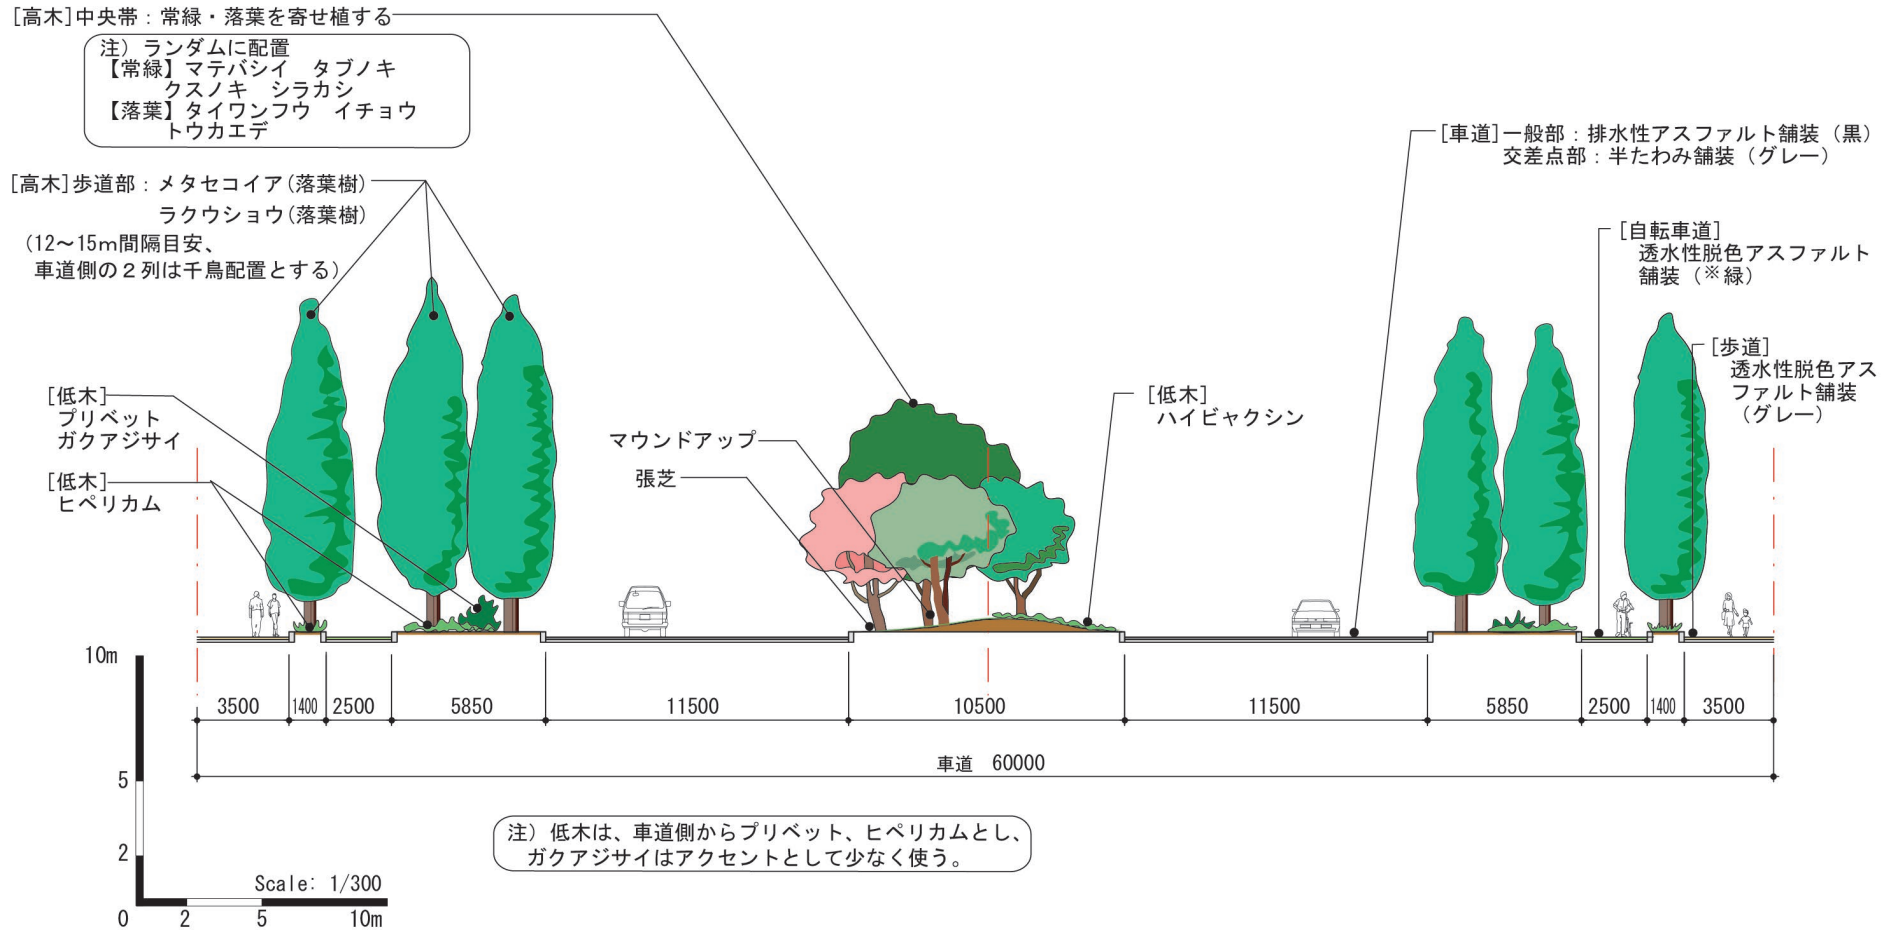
道路植栽計画図(臨港道路アイランドシティ1号線)断面図
